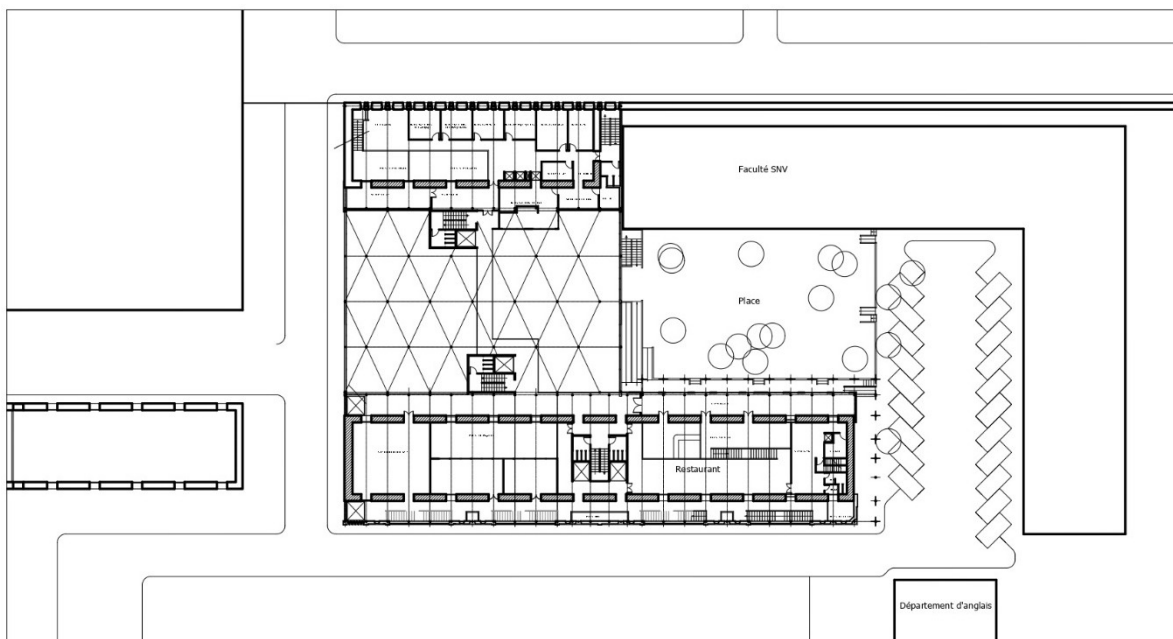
plan Mezzanine1C niv 3.80 ECH1/200
